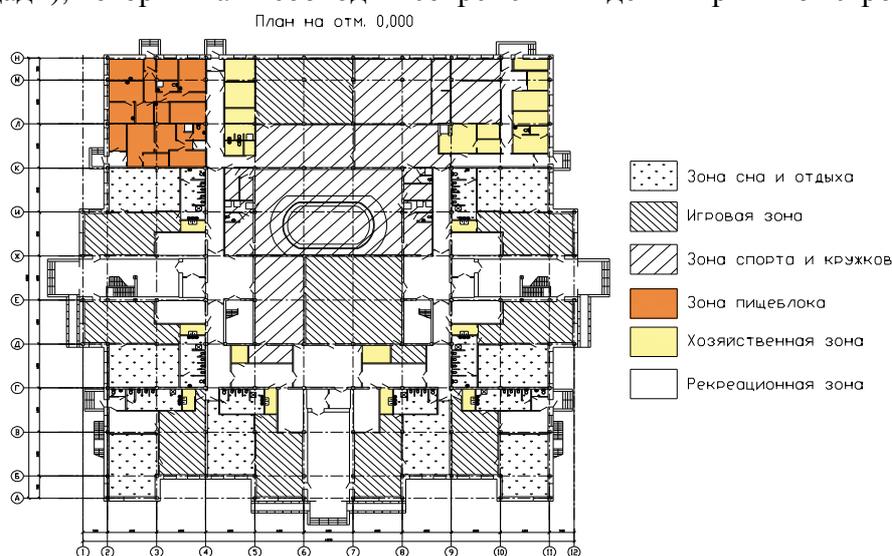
Схема зонирования помещений на плане первого этажа, проектируемого детского дошкольного учреждения
